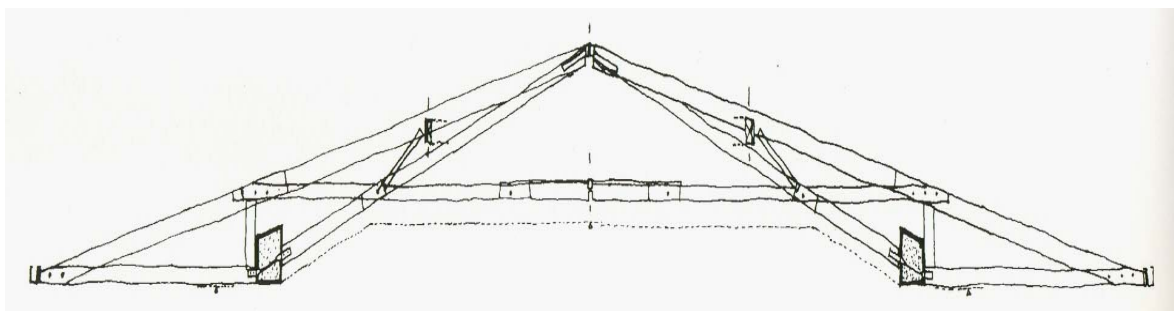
Estrutura de madeira de cobertura, obra: *Casa Rio Branco Paranhos*. Fonte: Artigas (1997)
